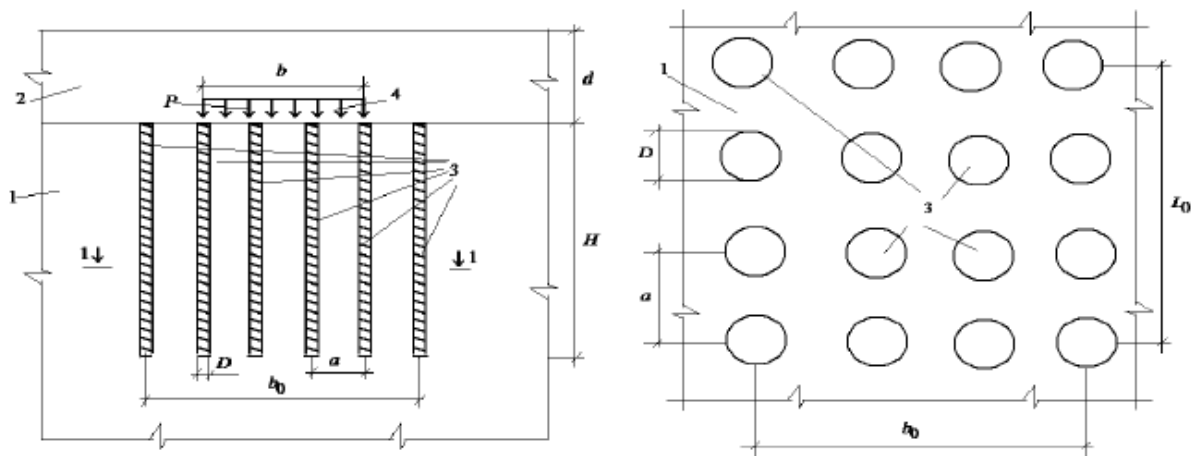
Розрахункові схеми армованої основи: 1 – основа; 2 – ґрунт вище підшви фундаменту; 3 – армовані елементи; 4 - навантаження
